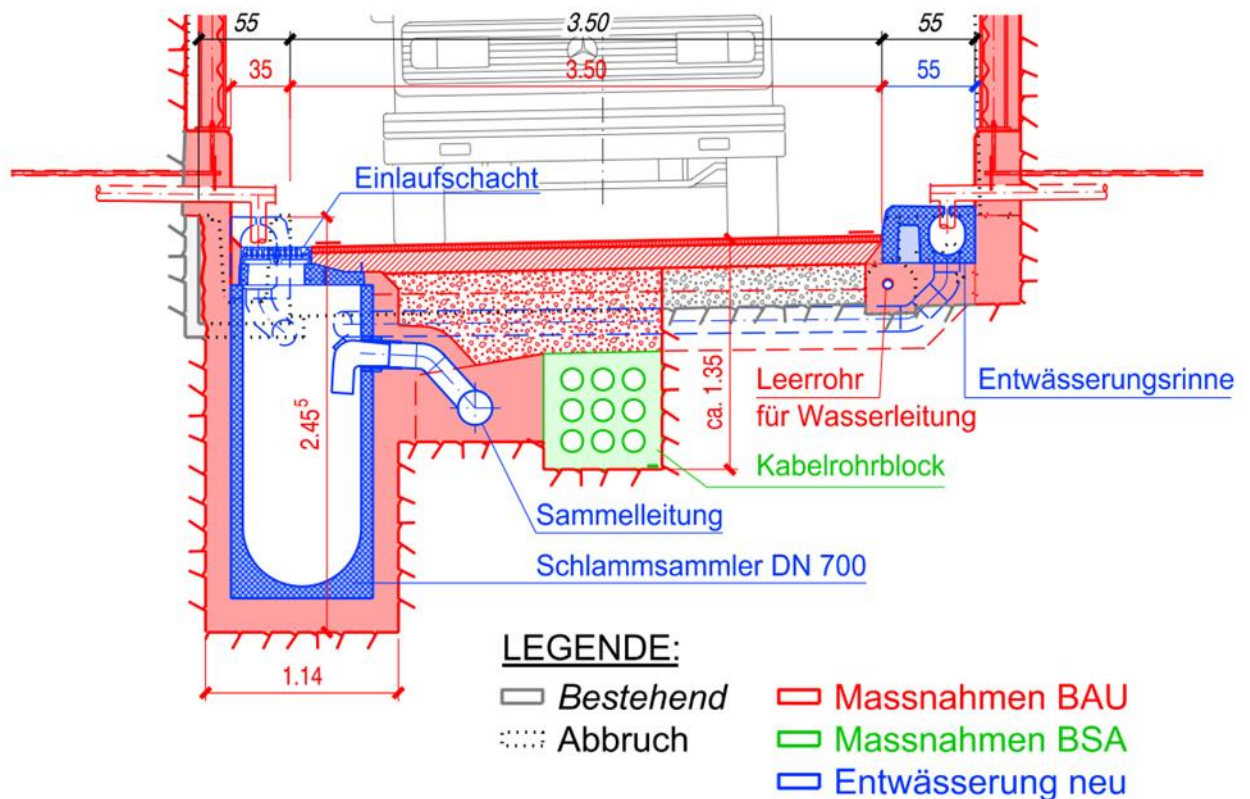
Querschnitt der Tunnelentwässerung mit Entwässerungsrinne, Schlammsammler und Sammelleitung
